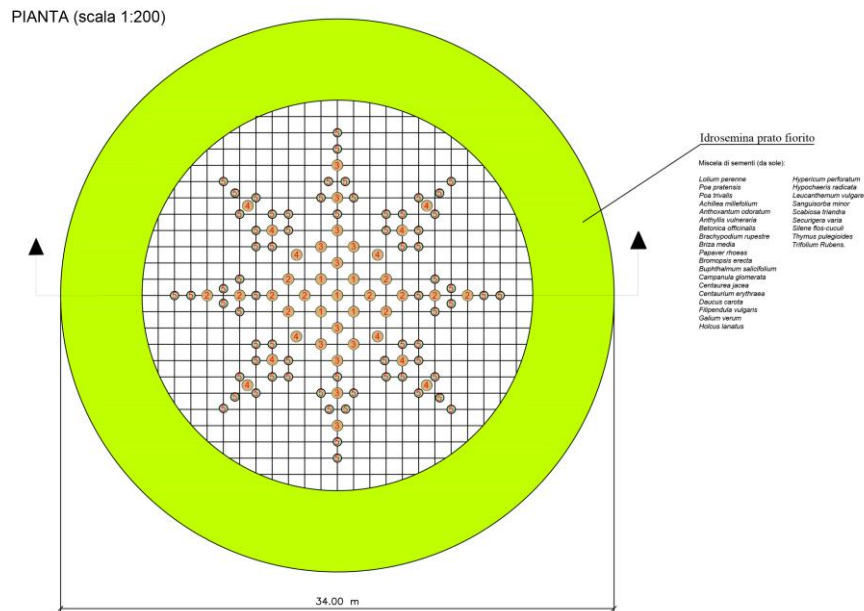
Pianta rotatoria modulo PI-RO 1
